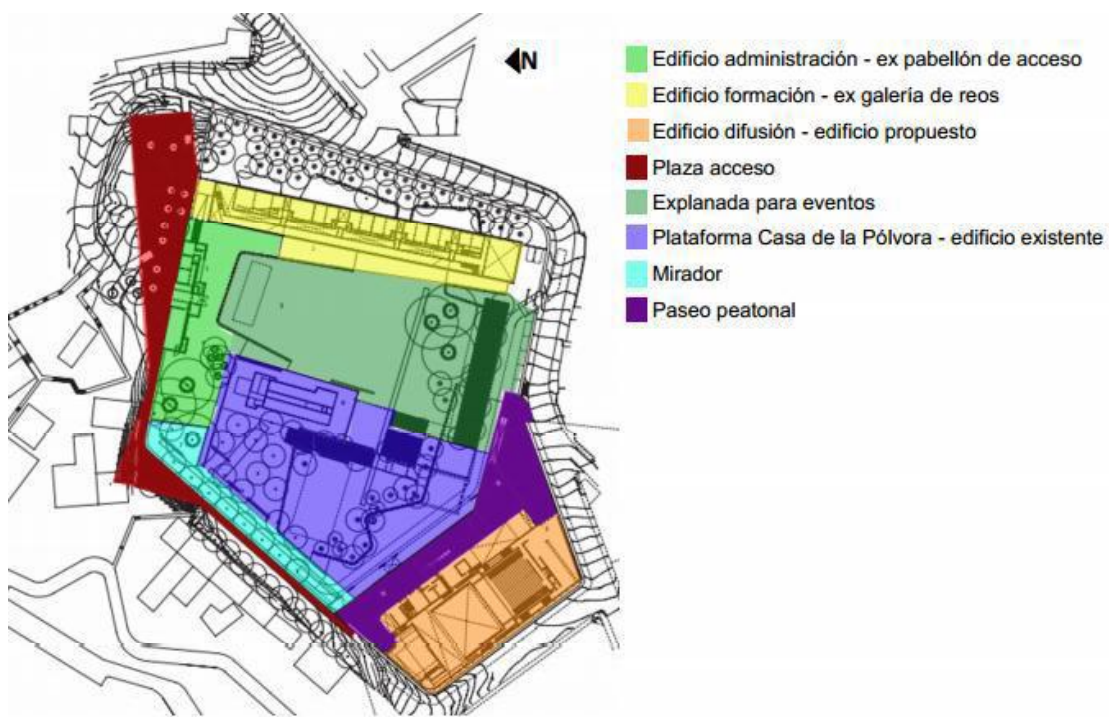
PLANTA DE CONJUNTO DE PARQUE CULTURAL
